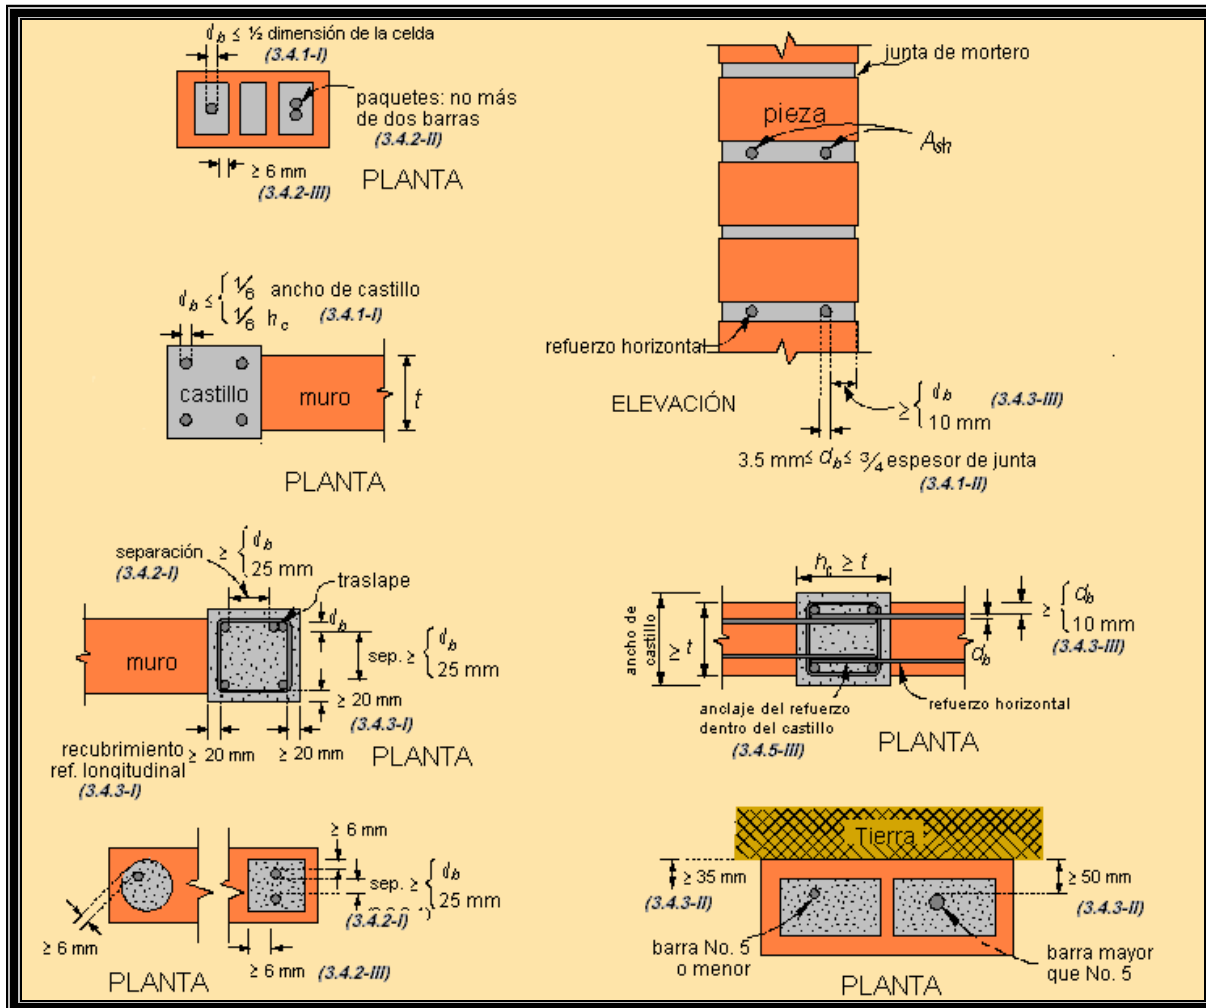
Tamaño., colocación y protección del refuerzo
